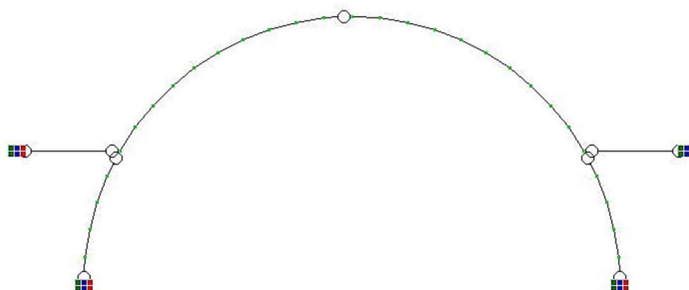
Схема арки у вигляді «механізму» з повними шарнірами
